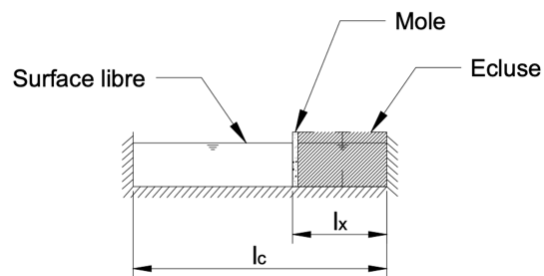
Coupe transversale d'un avant-port (schéma)
